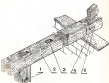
Удлинение балки перекрытия: 1 — стойка веранды, 2 — балка веранды, 3 — паз под шип или вертикальную стойку, 4 — обшивка дола, 5 — соединительный узел.
